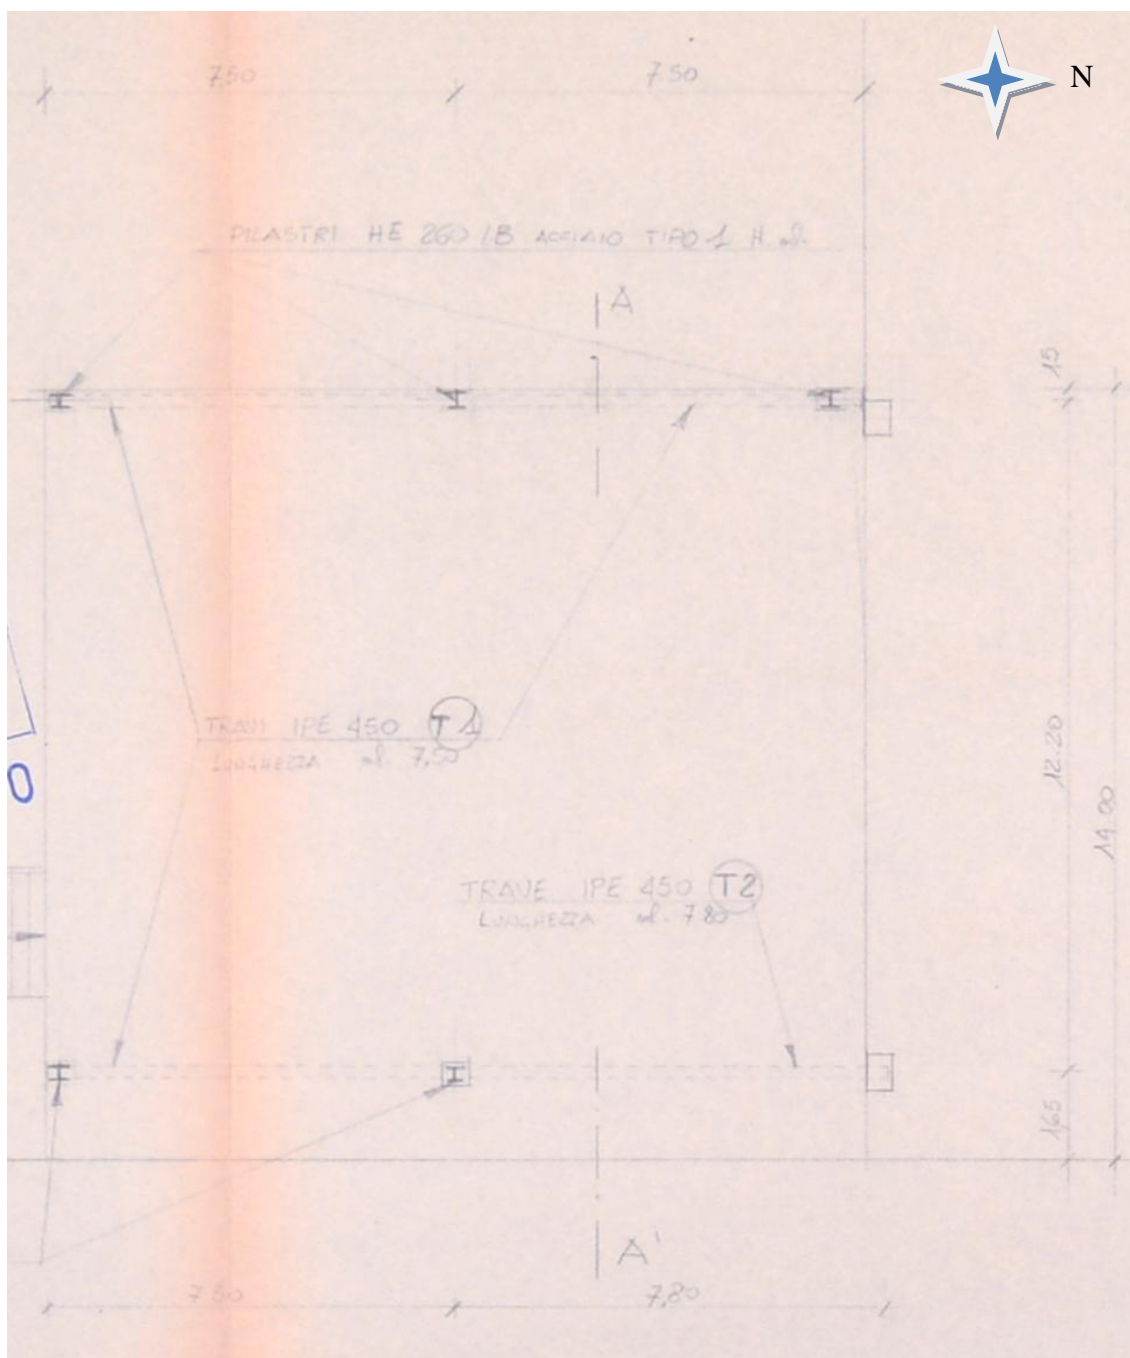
Particolare di A.1990.a.sa.T01 - Struttura in acciaio - Pianta
